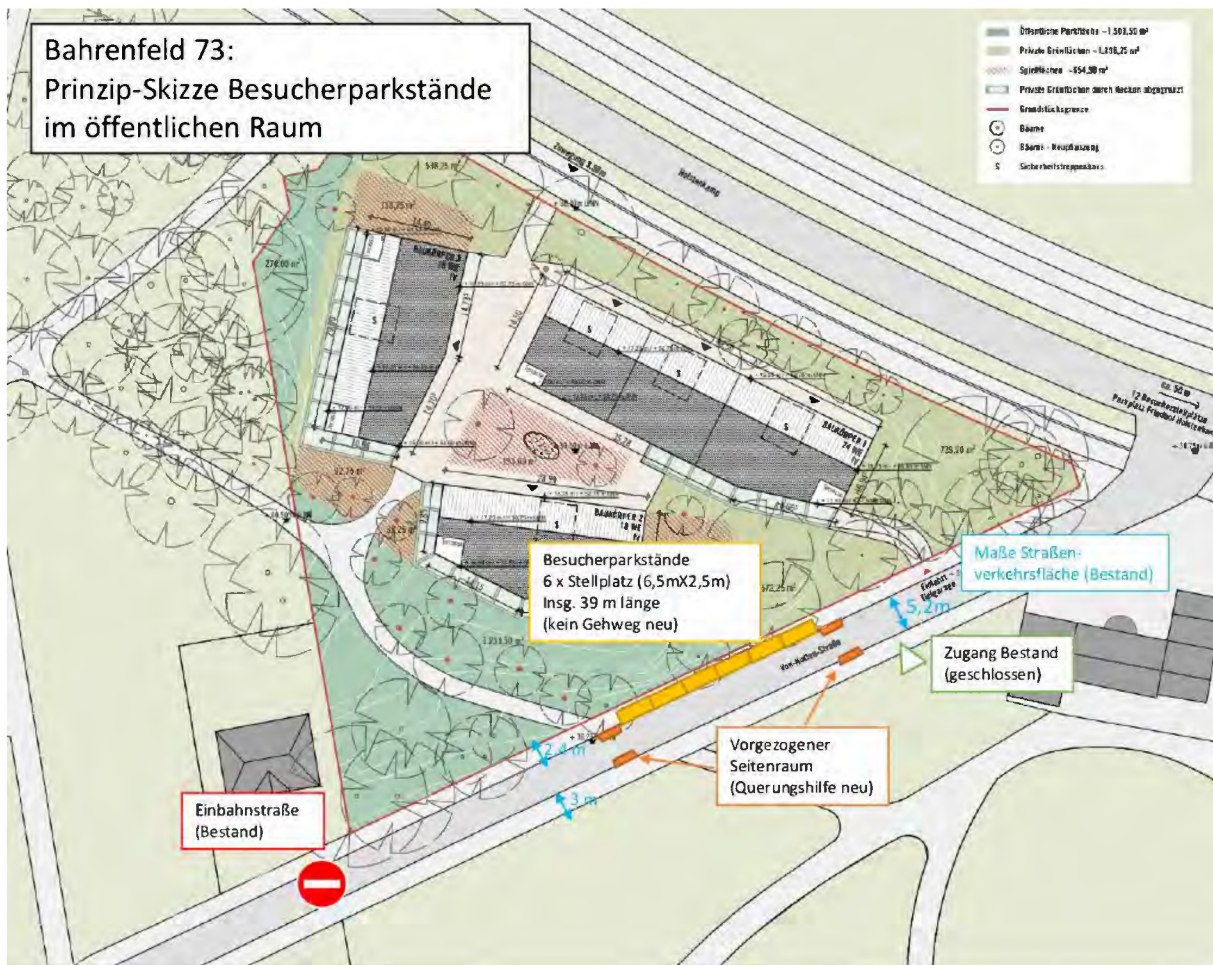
Prinzip-Skizze zur Verortung der Besucherparkstände (Quelle: Bezirksamt Hamburg Altona, Stand 2024)
